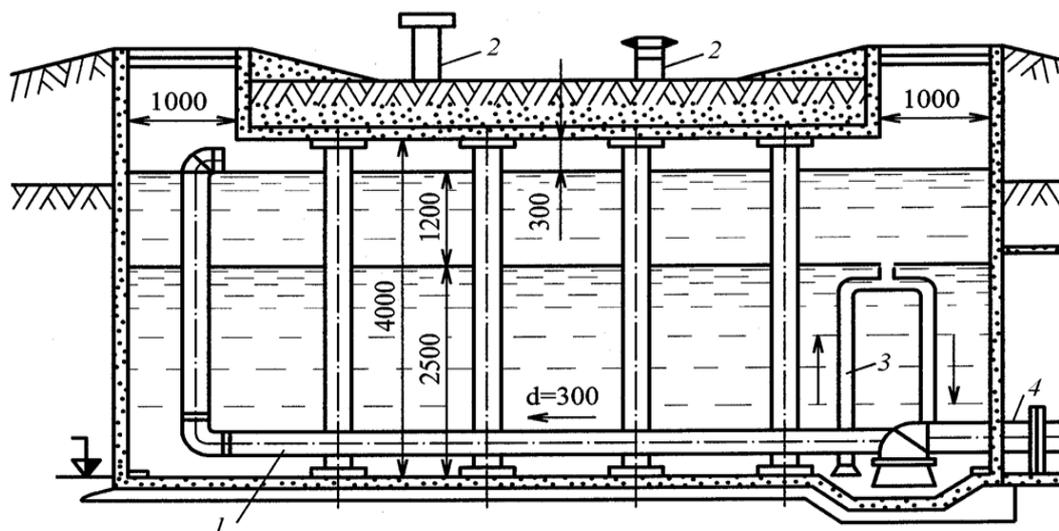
Устройство резервуара чистой воды: 1 - подающий трубопровод; 2 - вентиляционная труба; 3 - трубопровод отбора воды (всасывающий трубопровод хозяйственно-питьевых насосов); 4 - трубопровод отбора воды на пожаротушение
